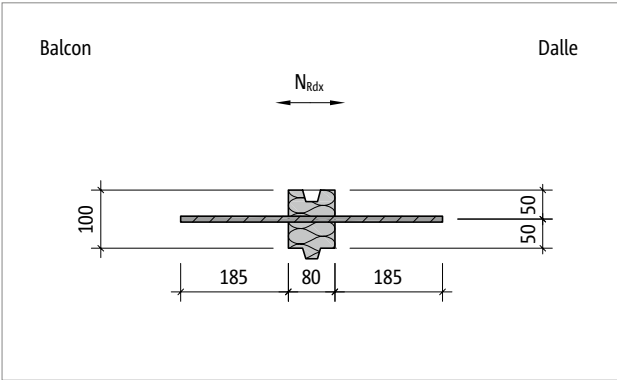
Schöck Isokorb® T Type H-NN1 : Plan de base du produit
